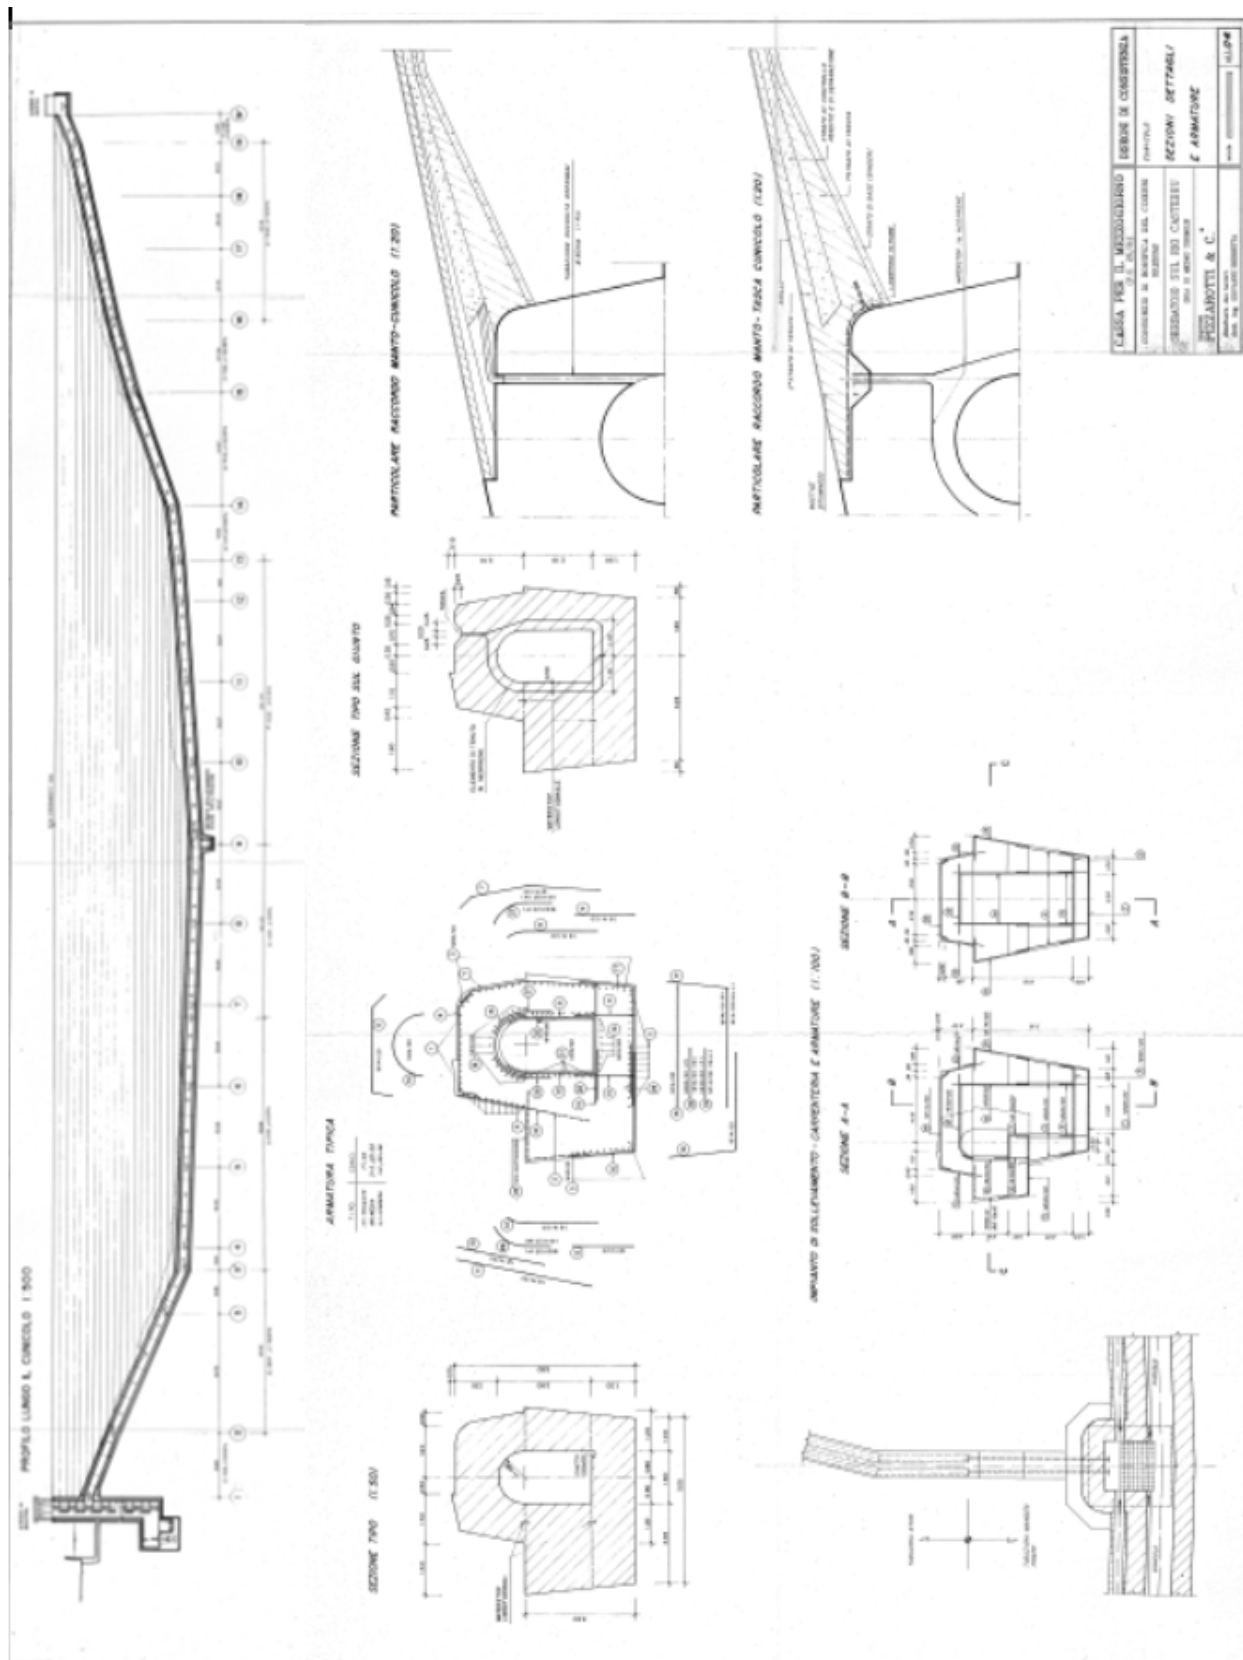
Medau, Galleria d'ispezione, Profilo longitudinale e sezione tipica
